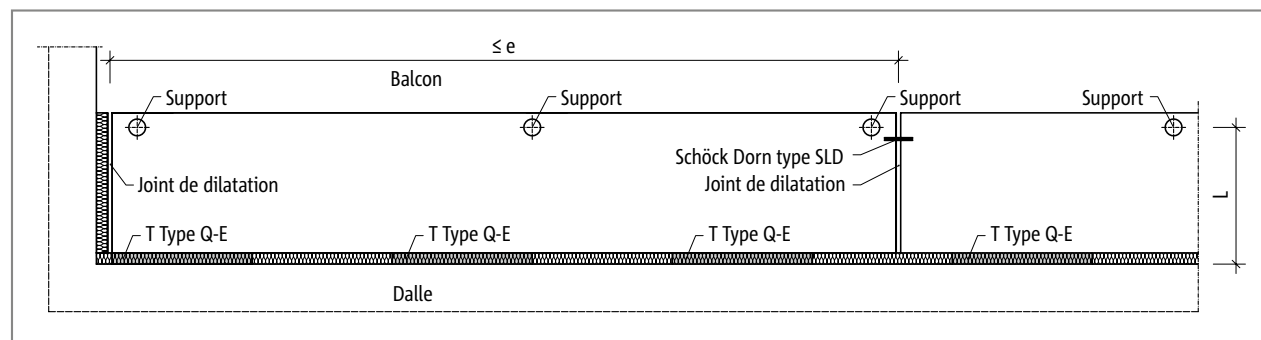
Schöck Isokorb® T Type Q-E : Disposition des joints de dilatation
